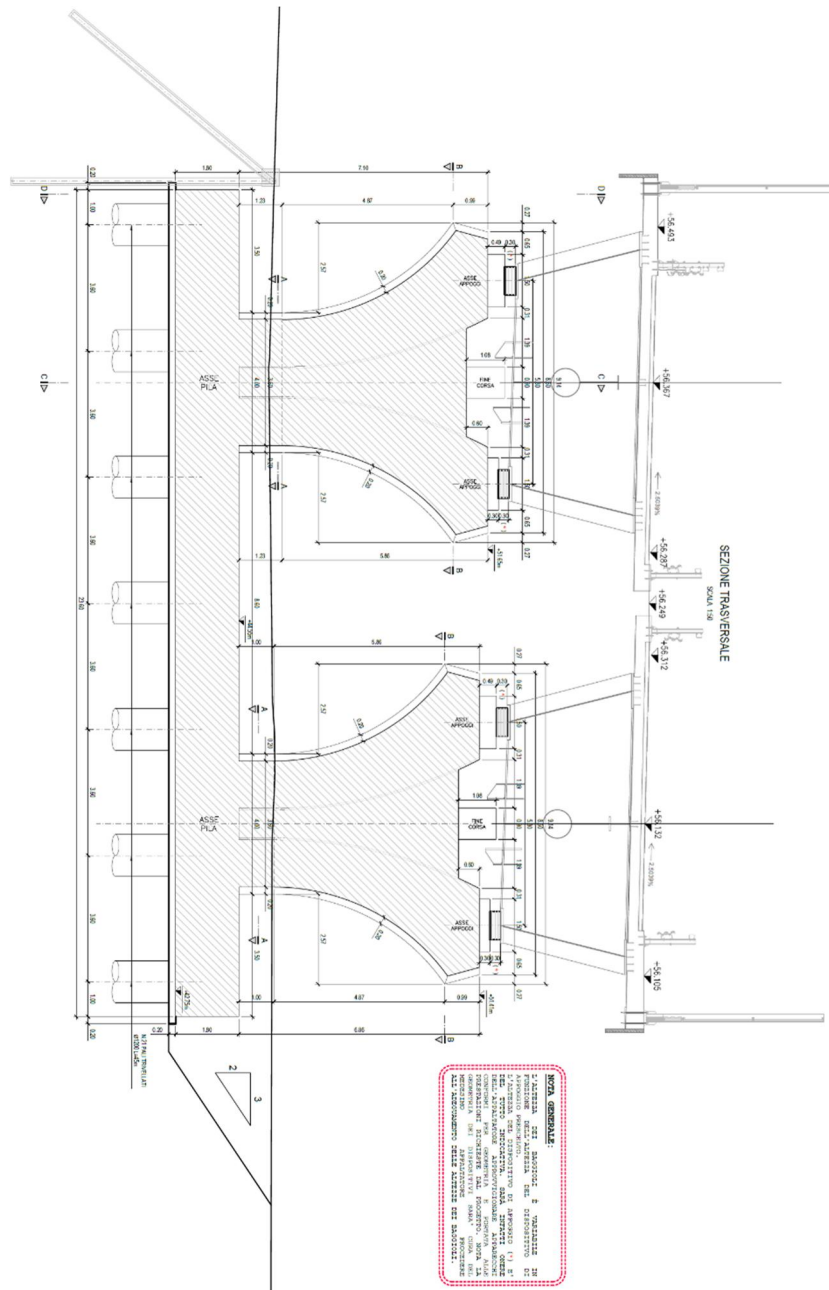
Sezione Tipica Trasversale Pila (P3).
